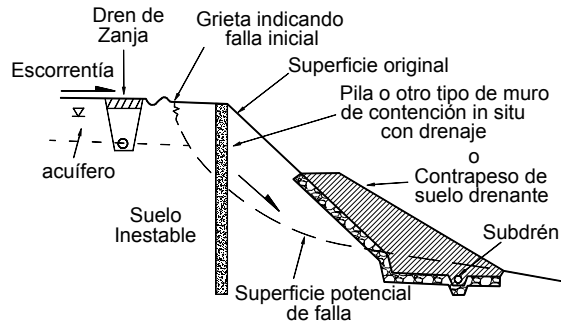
Esquema de un relleno de contrapeso además de una estructura de pilas o pilotes y un sistema de subdrenaje.
